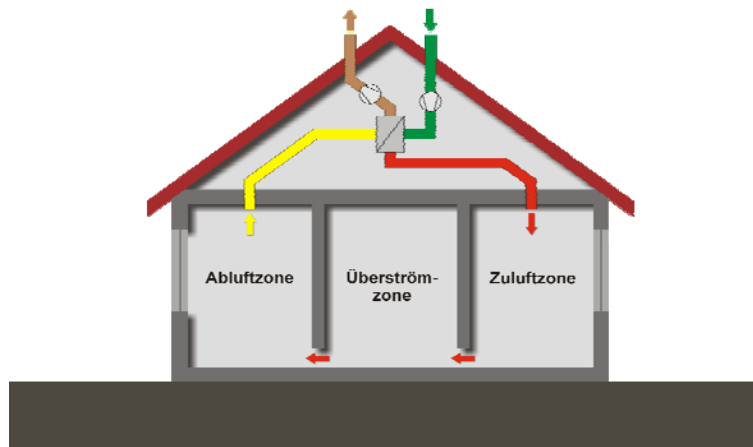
Prinzip einer mechanischen Lüftungsanlage mit Wärmerückgewinnung [IGS]
